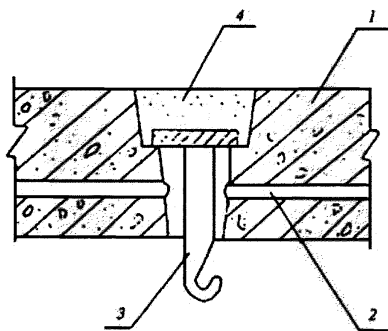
Схема конструктивного решения выпуска провода из перекрытия к потолочному светильнику (перекрытие со сквозным отверстием):
